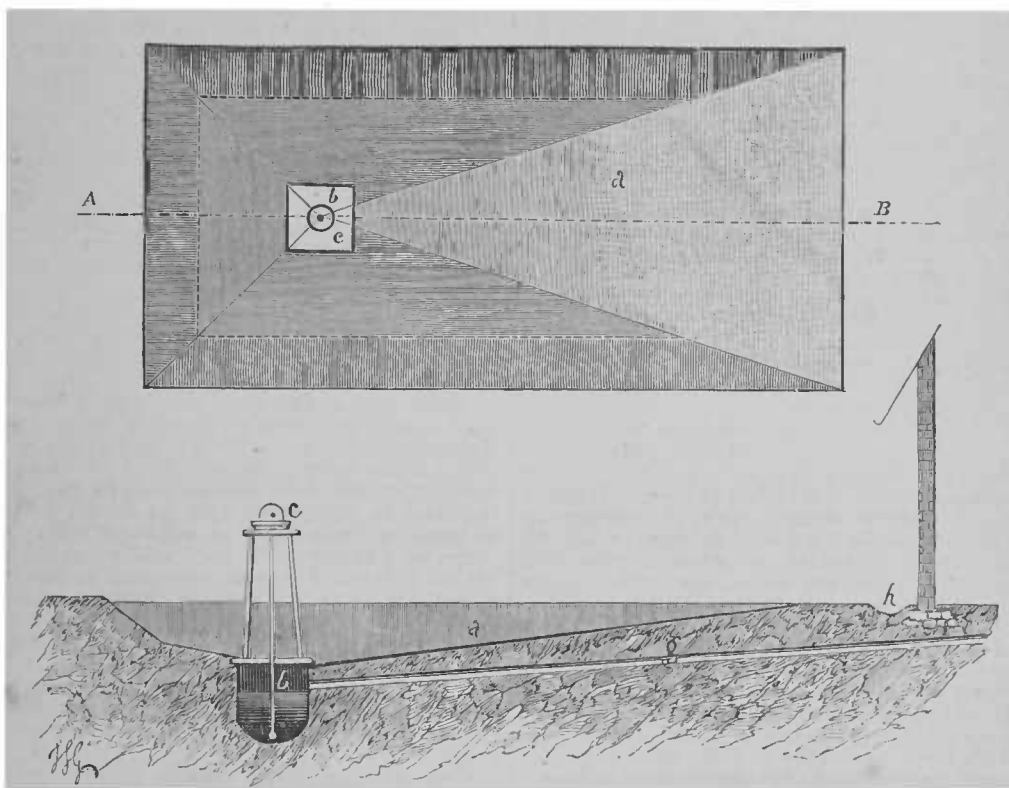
Plan et coupe longitudinale d'une fosse à fumier sans mur : a, emplacement du fumier; b, fosse à purin; c, pompe à purin; g, conduit à purin; h, rigole destinée à écarter les eaux pluviales.
